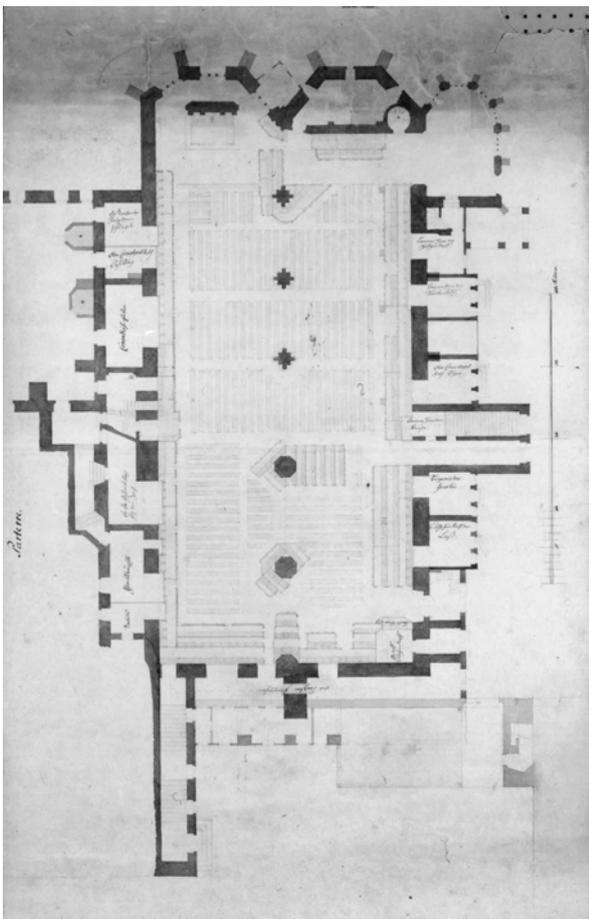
Grundriss der Franziskanerklosterkirche vor 1864
